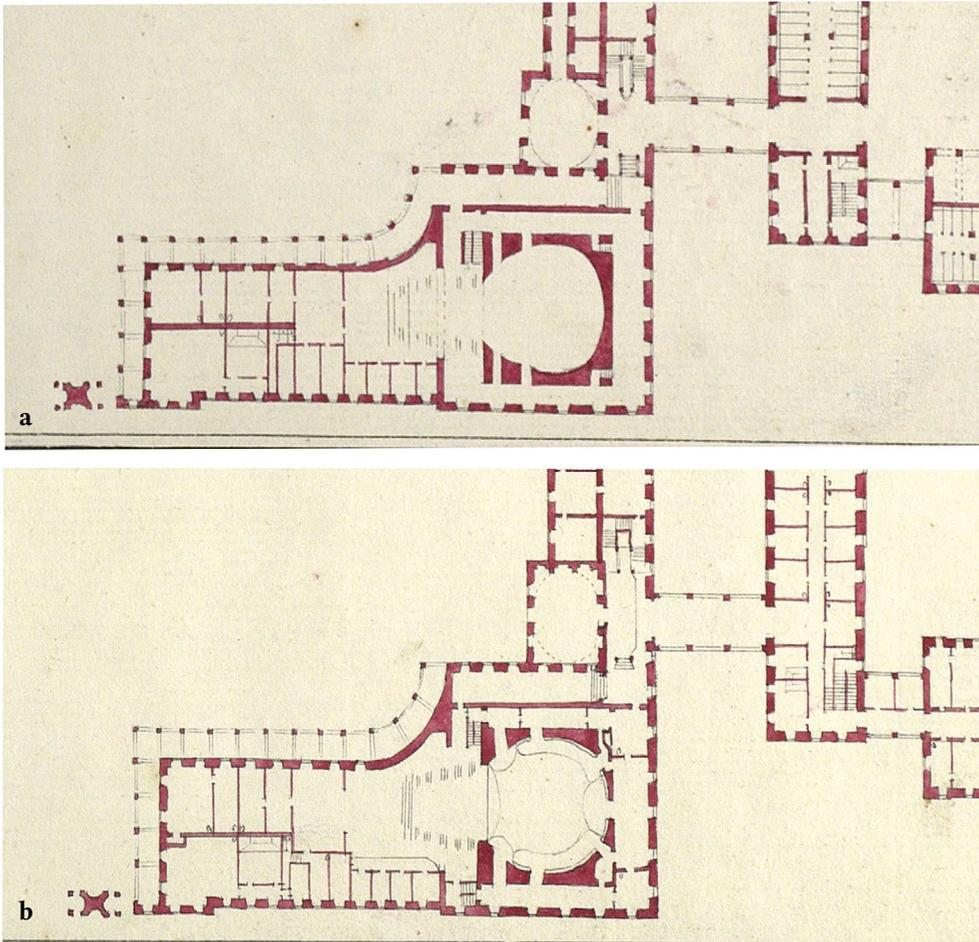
Schönbrunner Schlosstheater. a: Erdgeschoßgrundriss; b: Grundriss des ersten Ranges; Details aus Gesamtgrundrissen des Schlossareals von Mohr von Mohrenberg, um 1780.
